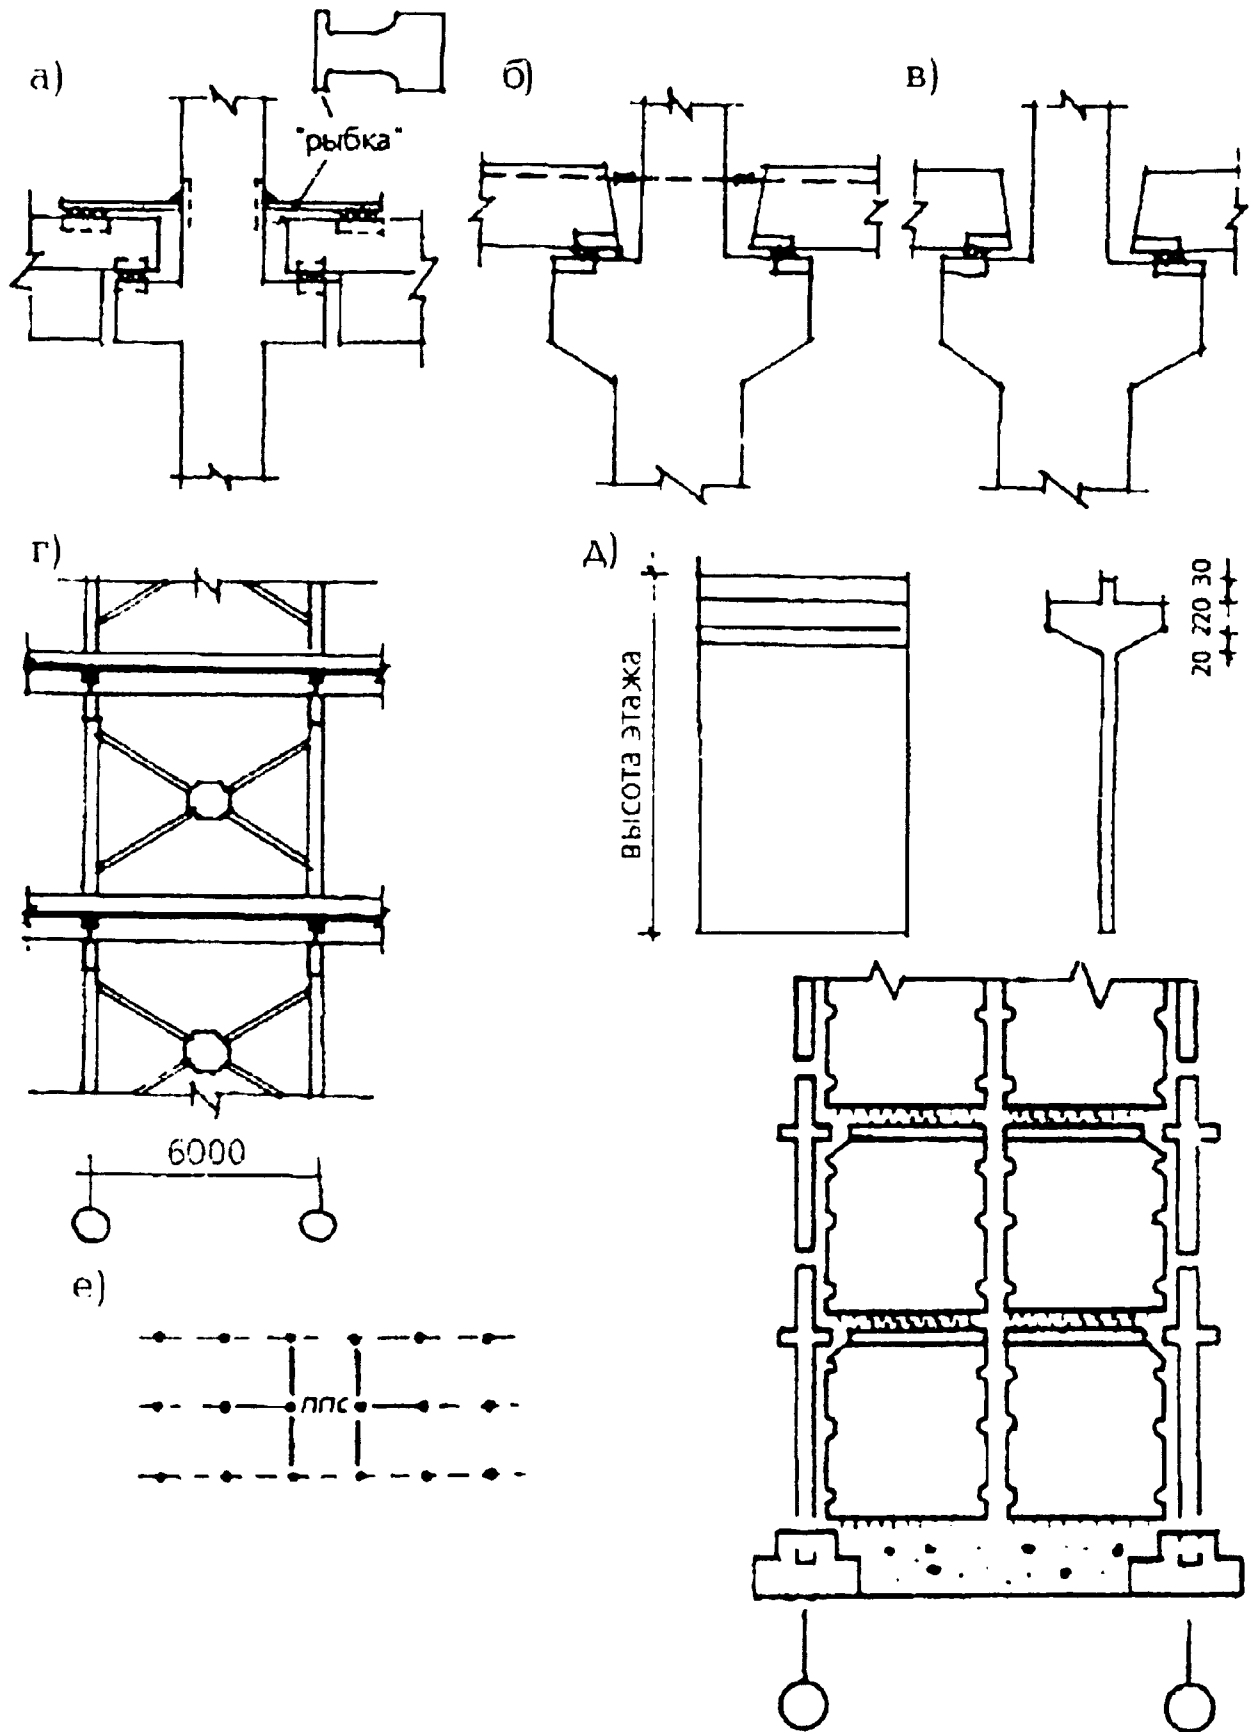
Стоечно-балочный каркас. Узлы сопряжений ригеля и колонны. Элементы жесткости: а - стык колонны и ригеля с помощью стального посредника («рыбки»); б - жесткий стык с помощью сварки выпусков арматуры; в - шарнирный (гибкий) стык колонны и ригеля; г - стальные крестовые связи между колоннами; д - стенки-диафрагмы жесткости; е - вариант размещения в здании пространственной связевой системы (ПСС)
